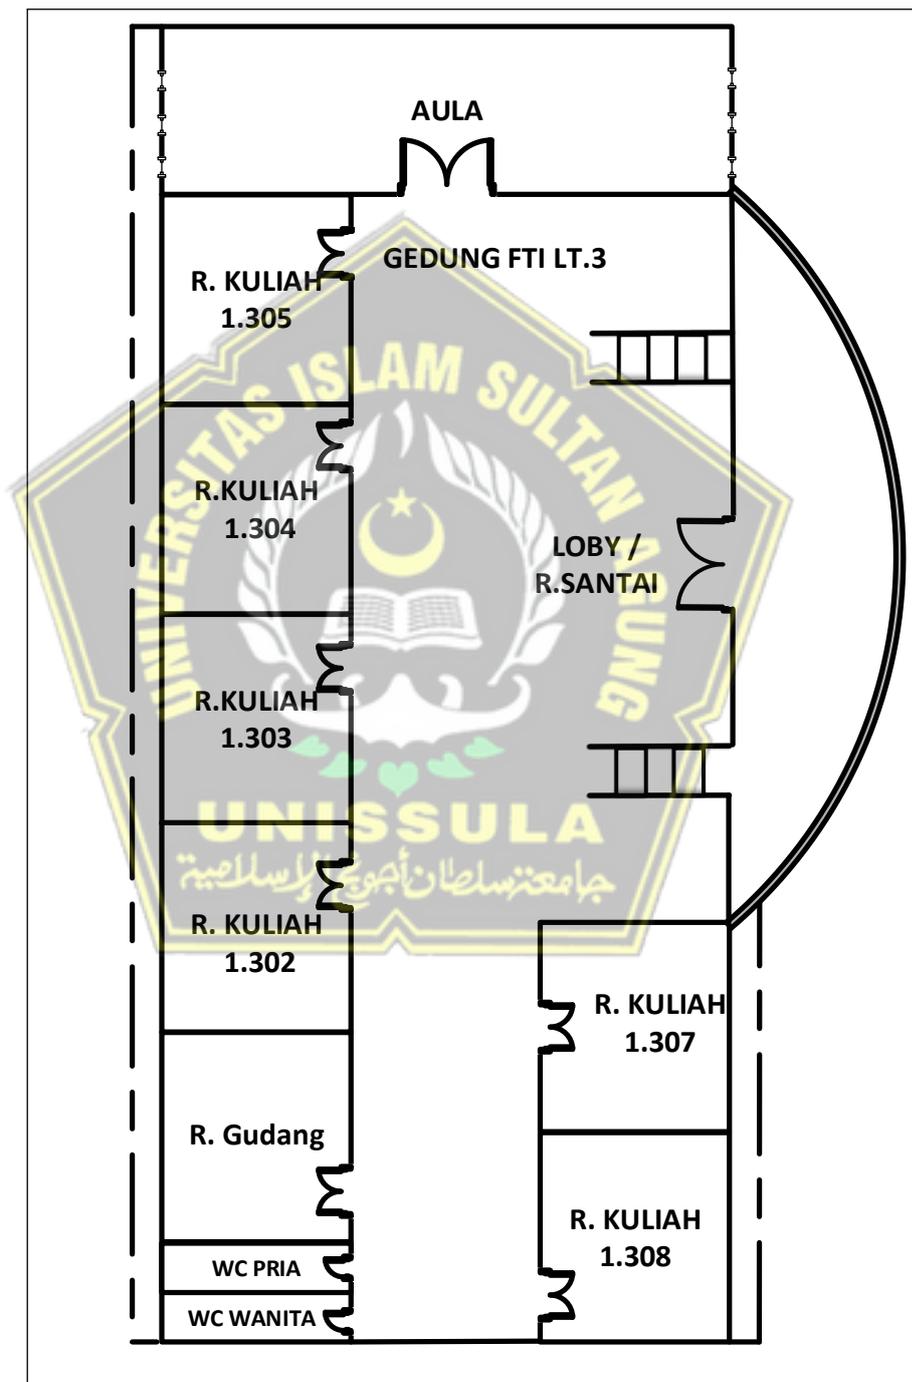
2 Denah Ruang FTI Lantai 1
